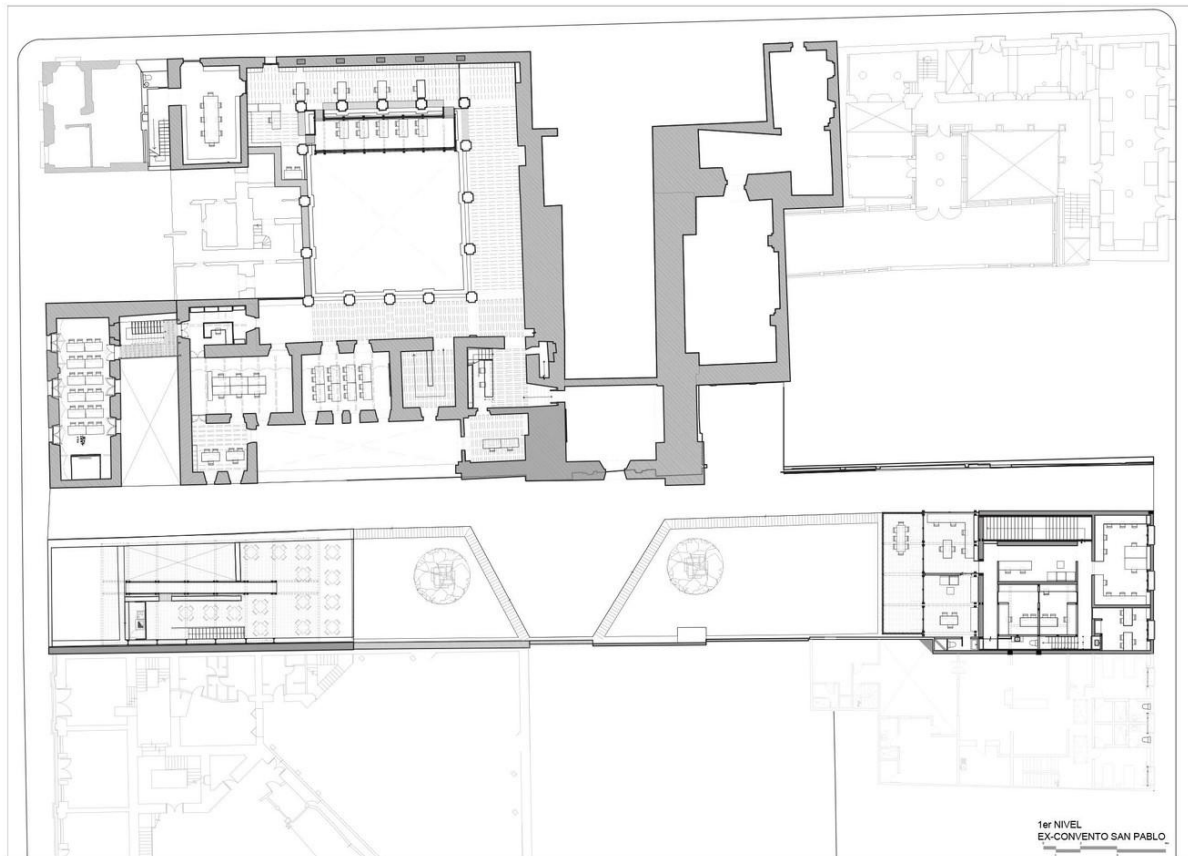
Planta Baixa. Fonte: Plataformaarquitectura
